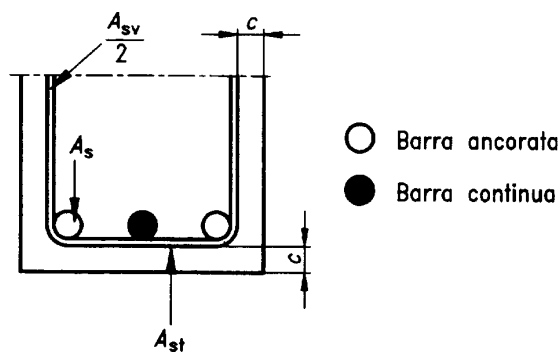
Armatura addizionale in zona di ancoraggio per barre longitudinali di diametro maggiore di $\lfloor 32 \text{ mm} \rfloor$ e in assenza di compressione trasversale
